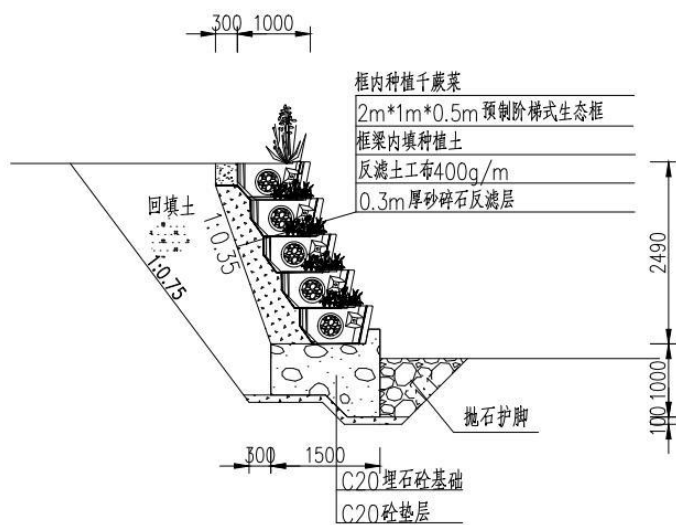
直立式-混凝土生态框生态挡墙护岸断面示意图
